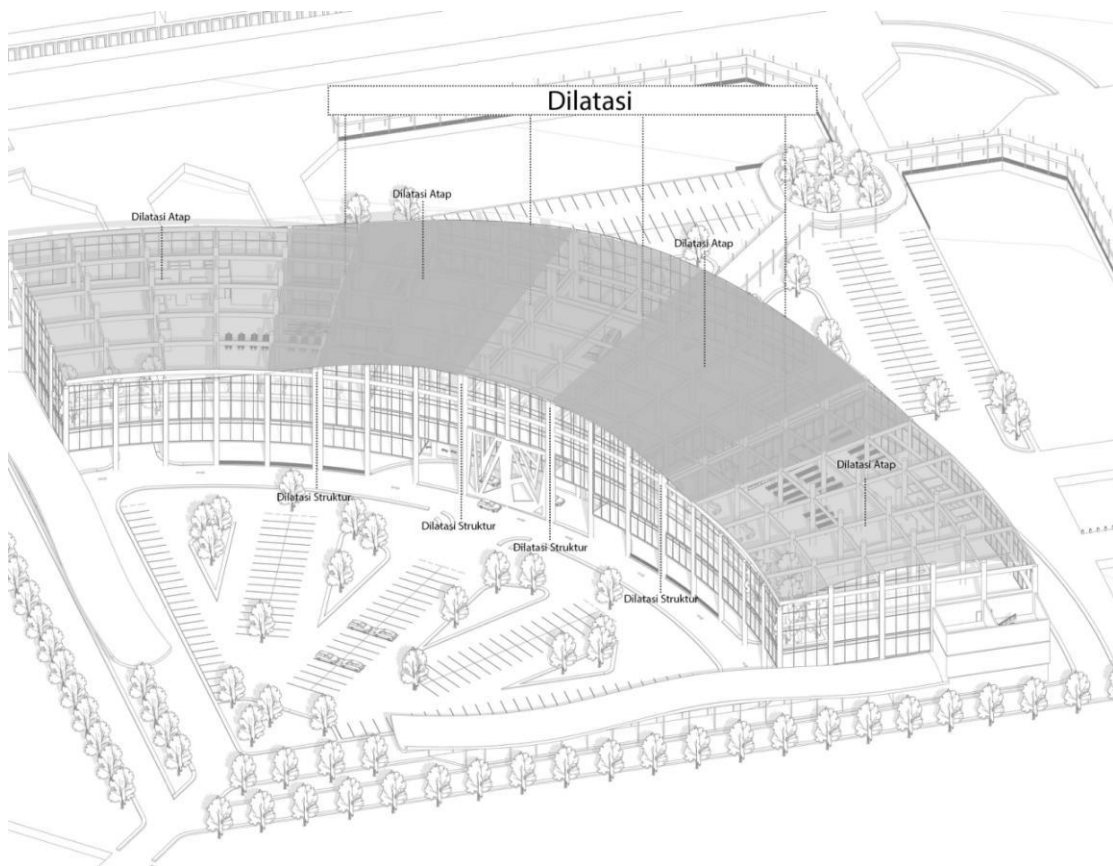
A Detail Bentuk dan Tampilan Bangunan
